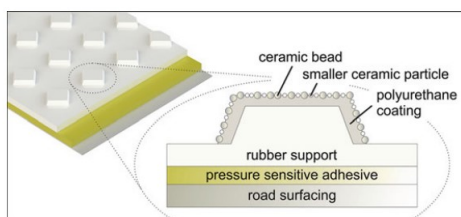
Esquema de aplicação adesiva na construção civil [10].
